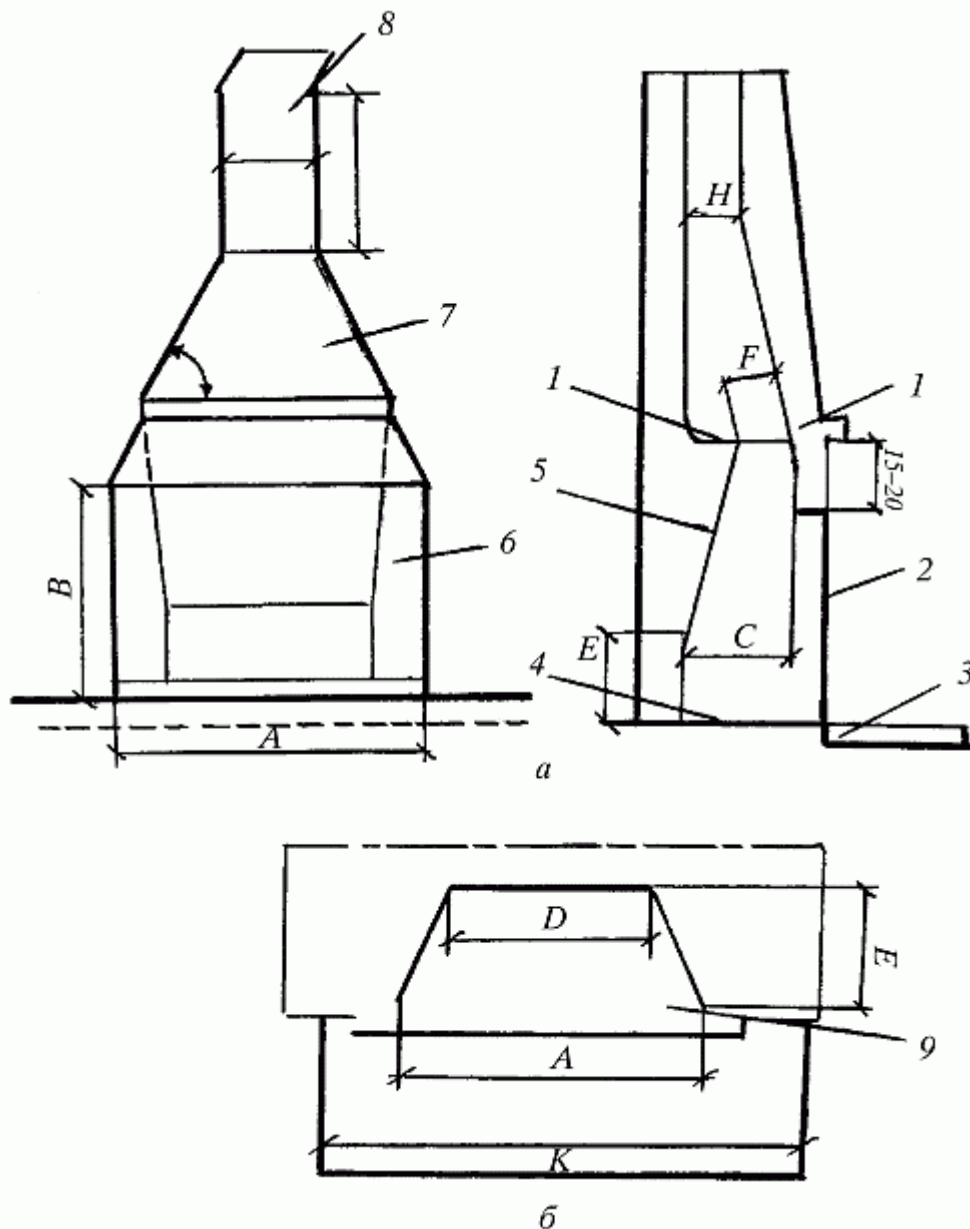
Каминь с боковым расположением дымового канала: а – угольный: 1 – перекидной клапан; 2 – выход нагретого воздуха; 3 – вход холодного воздуха; 4 – днище очага; 5 – задняя стенка; 6 – боковая стенка; 7 – дымовая коробка; 8 – труба б – дровяной: 9 – топочное пространство
